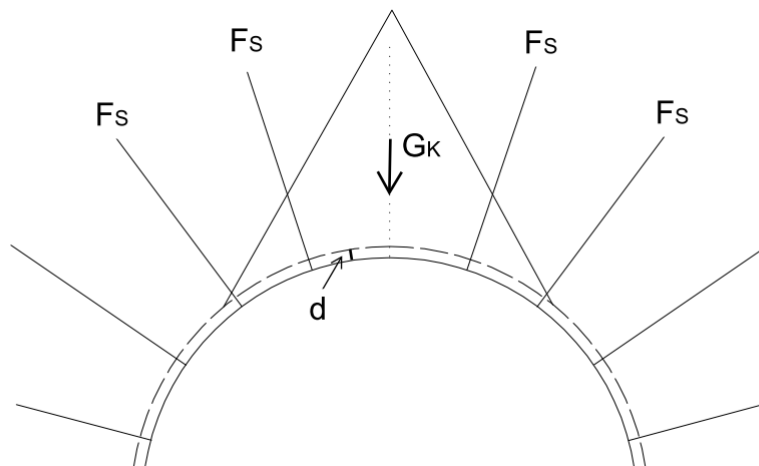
Gleichgewichtsbetrachtung „fallender“ Bruchkörper
